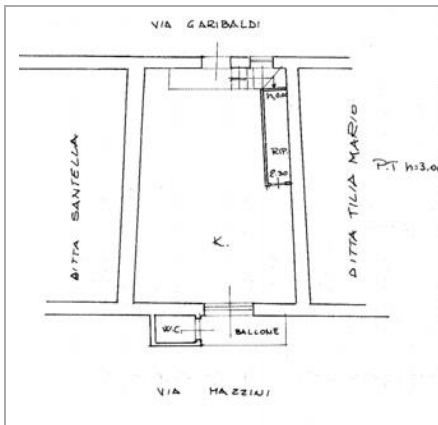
planimetria catastale Fg.10 Part.614 Sub.2 (abitazione - Piano Terra)
